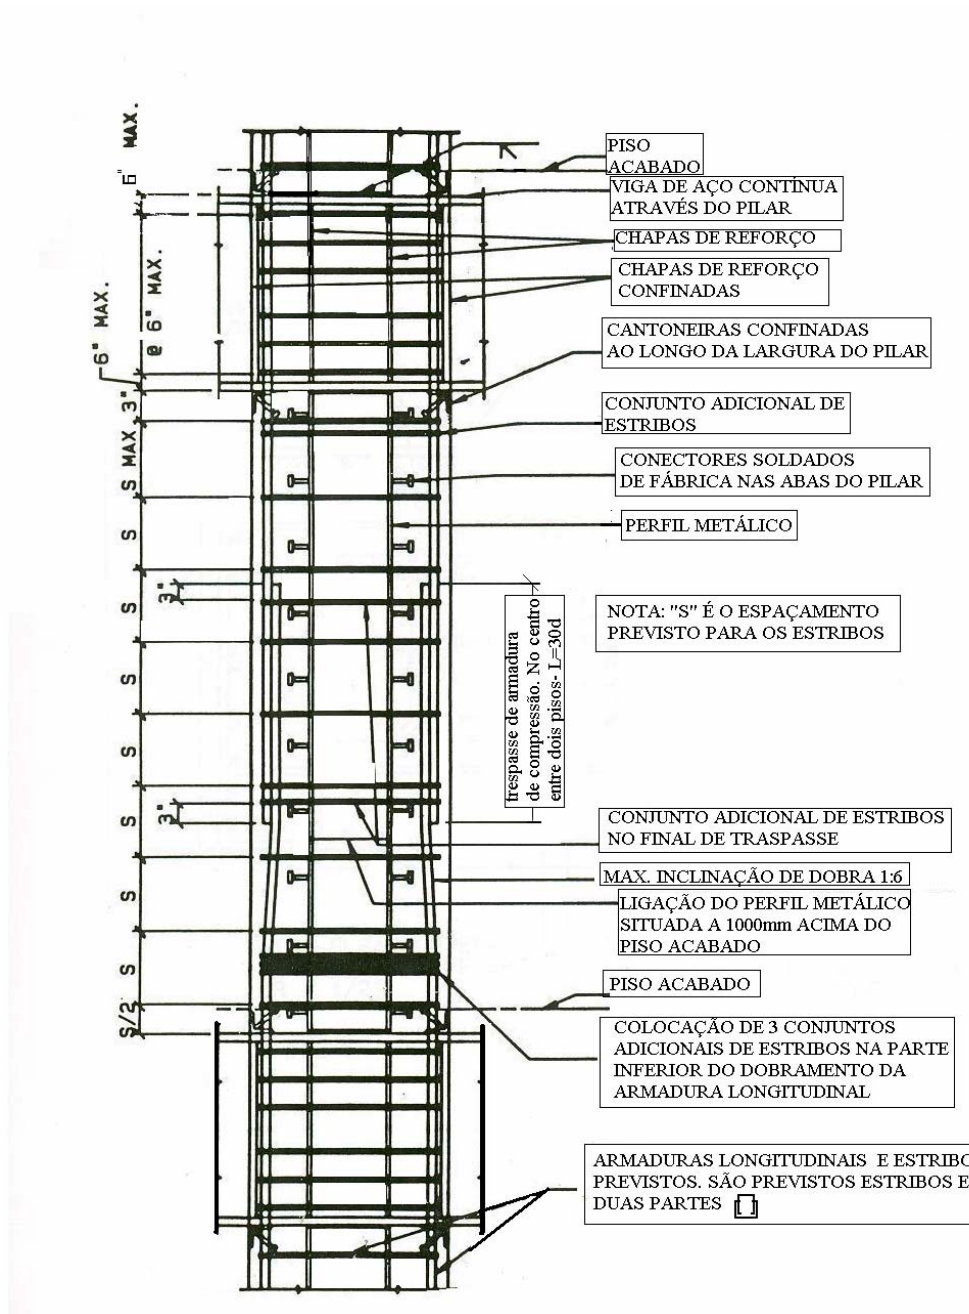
Pilar misto revestido -ZIC's e ZNA's, Fonte: AISC-Steel Design Guide
